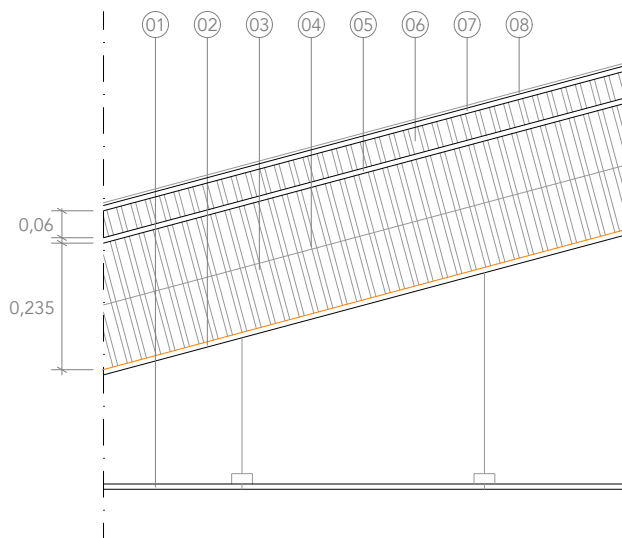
Cubierta tejada con forjado inclinado de vigas de madera de 23,5 x 3,8 cm de canto con falso techo de yeso laminado. Sistema constructivo propuesto.
